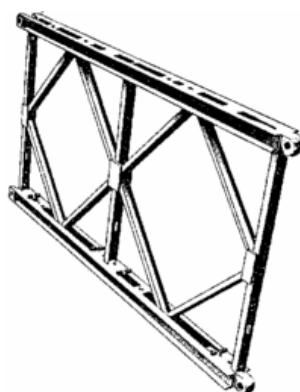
Painel de uma ponte Bailey (canadiansoldiers.com 1999)
